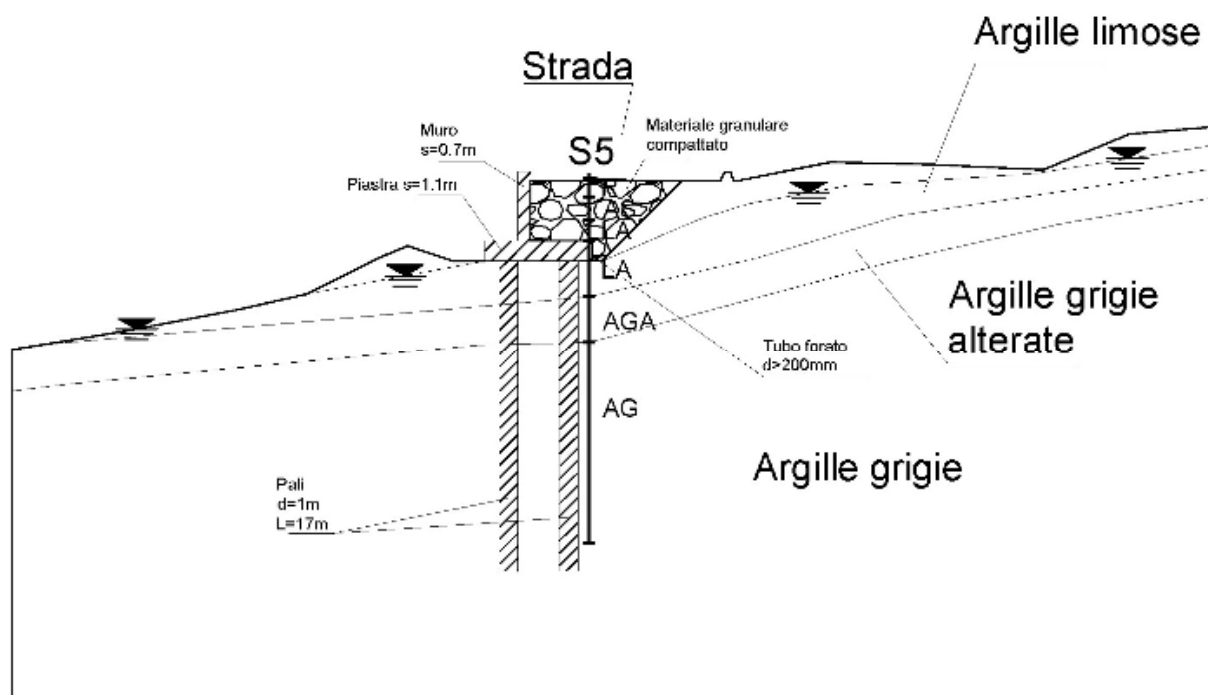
Dissesto al km 9+800. Sezione con schema degli interventi di consolidamento. Sulla parete verticale del muro saranno predisposti fori drenanti.
